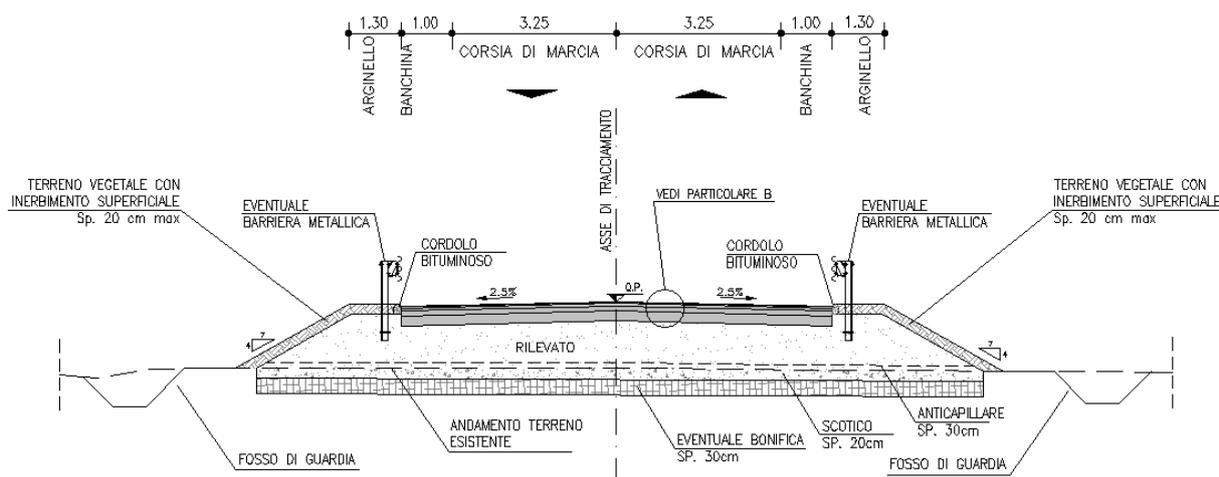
Sezione tipo Asse A, Asse B in rettifilo
